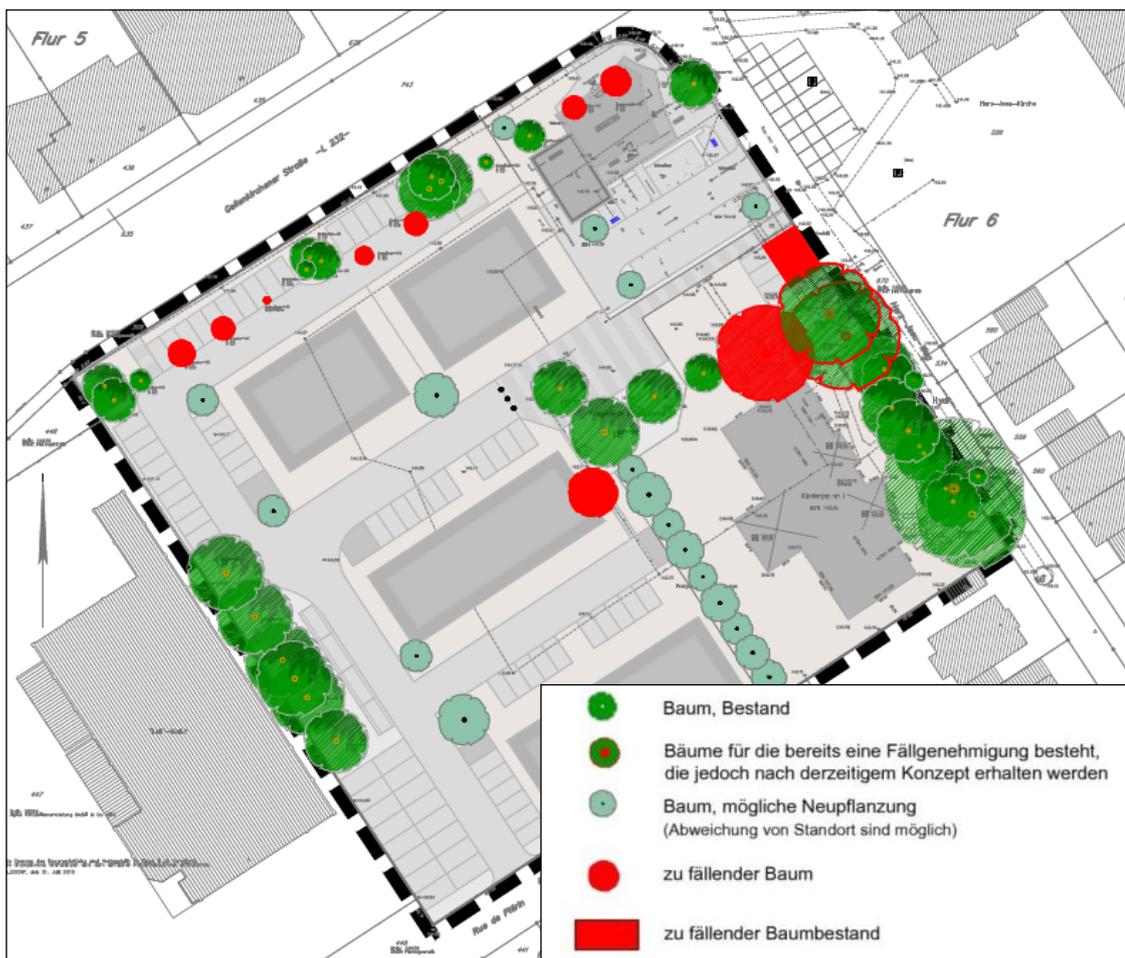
Baumbestand / Baumerhaltung nach Baumschutzsatzung
